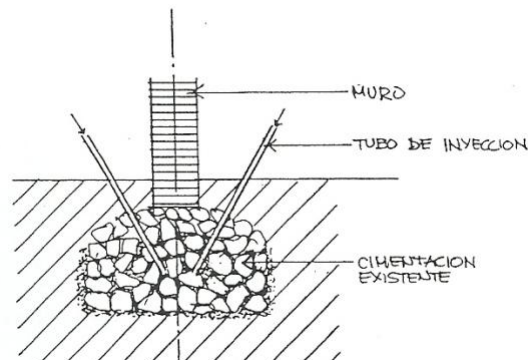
Refuerzo cimentación mediante inyección de lechada o mortero de cemento (Monjo, et al., 2001).
